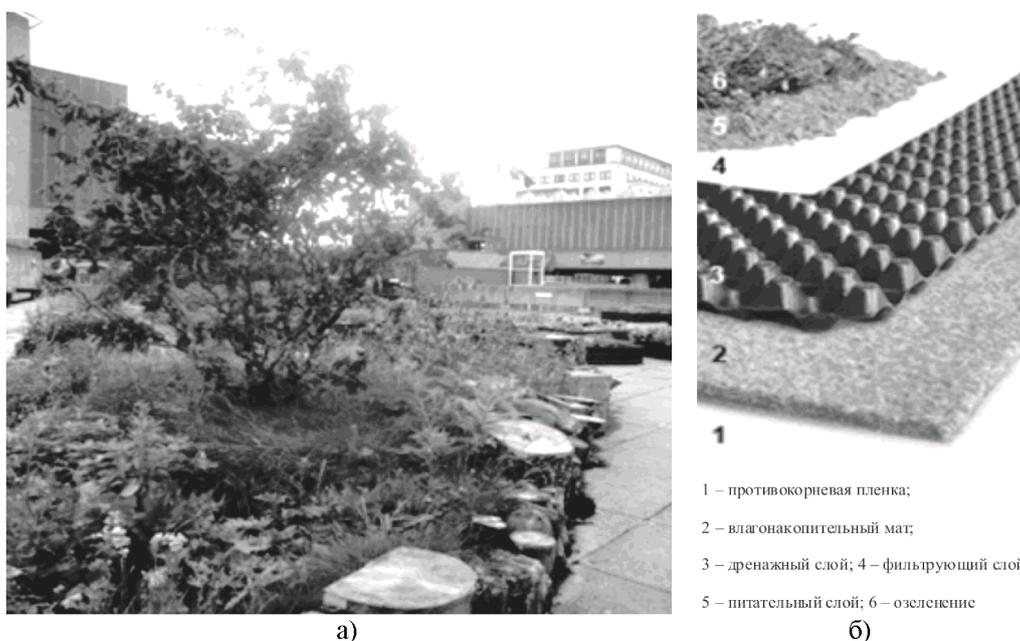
Сады на крышах: а) озелененная крыша Элизабетхолла в Лондоне (фото авторов); б) конструкция «пирога» озеленяемой кровли
